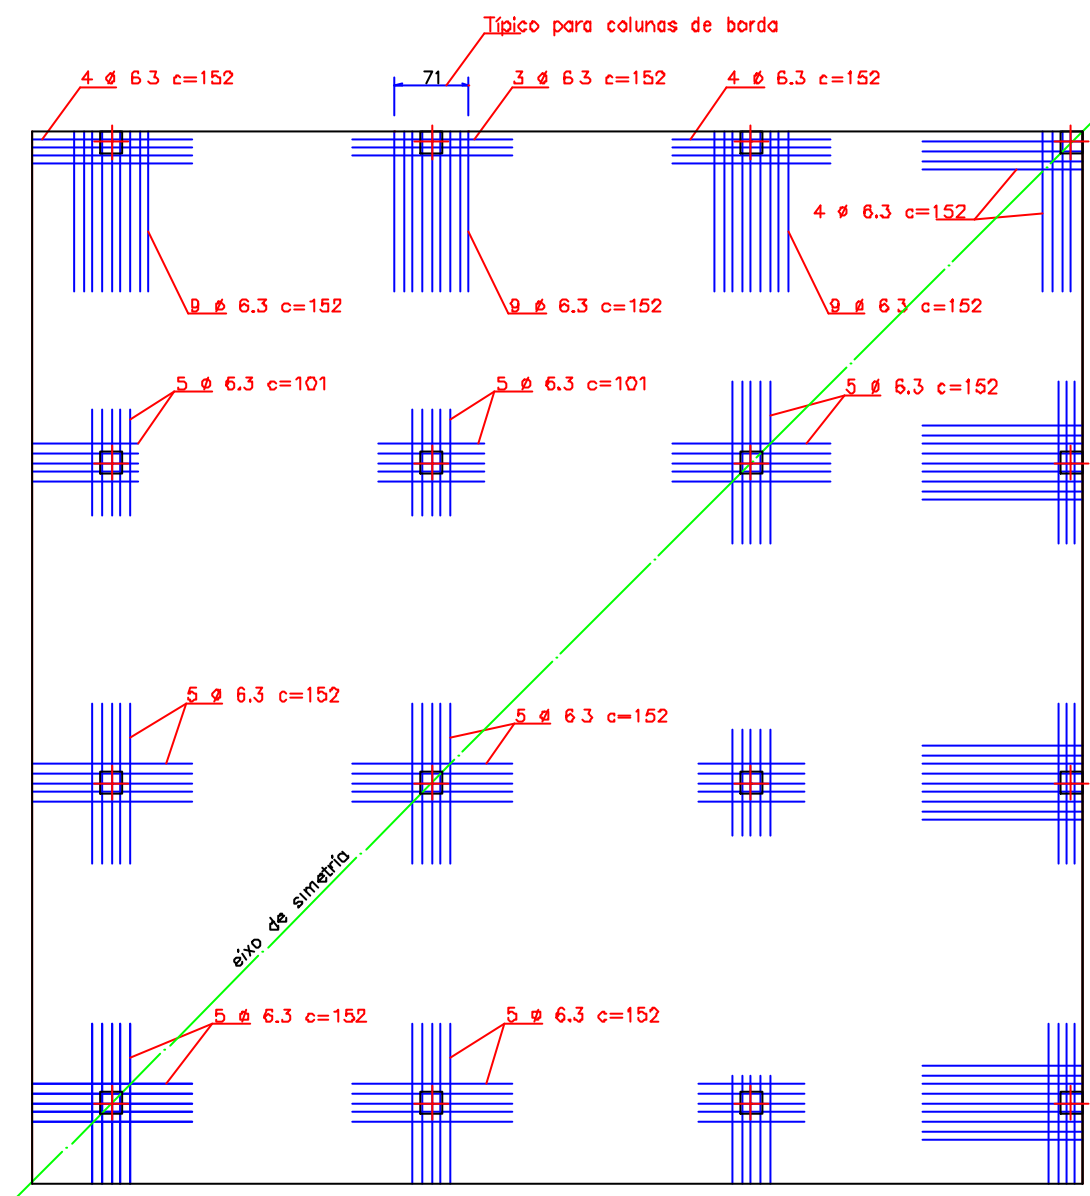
Detalhe da Armadura Aderente Superior na Laje I – 1974
